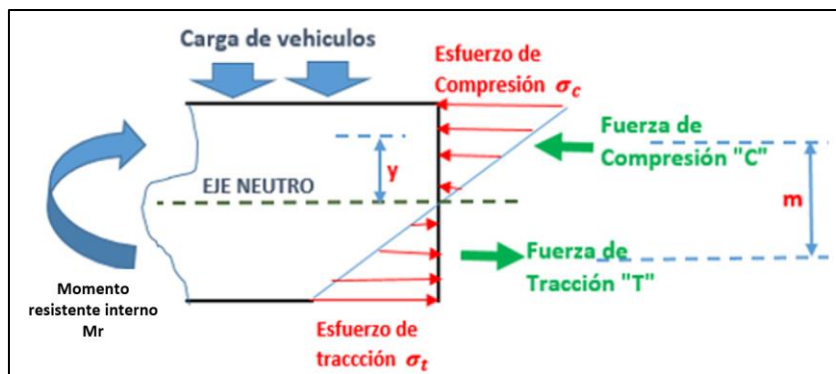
Esfuerzos en sección de la losa de concreto en rango elástico
